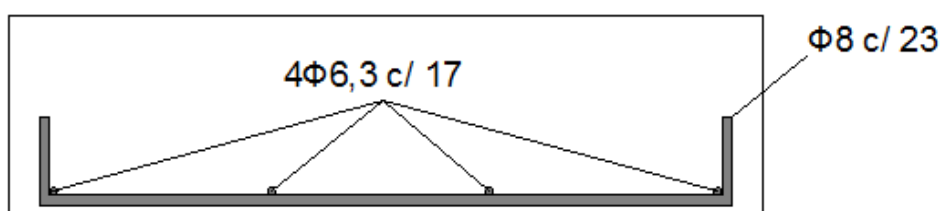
Disposição das armaduras nos trechos de paredes
